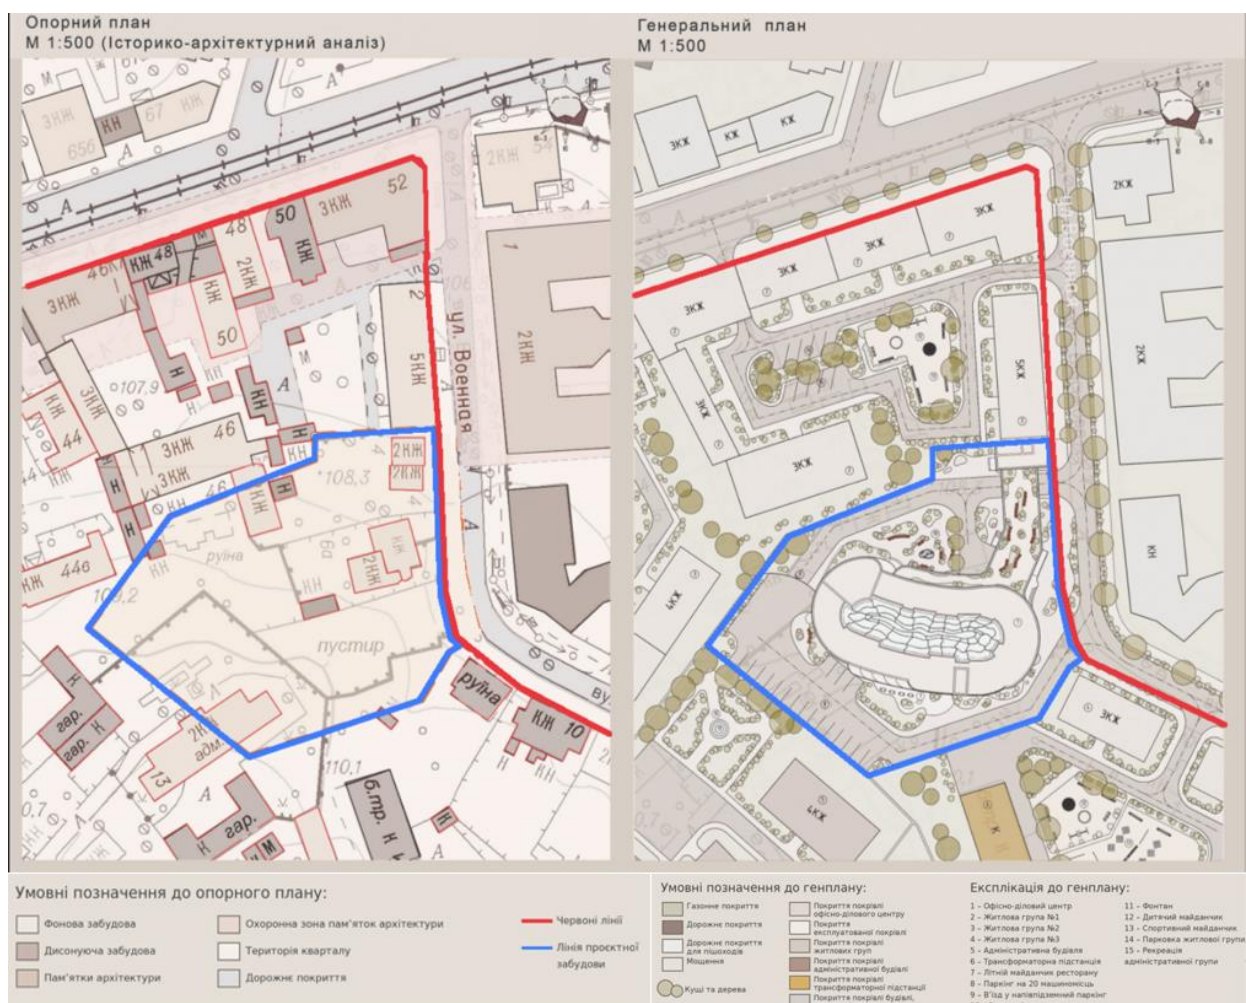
Опорний план та схема генерального плану обраної ділянки
